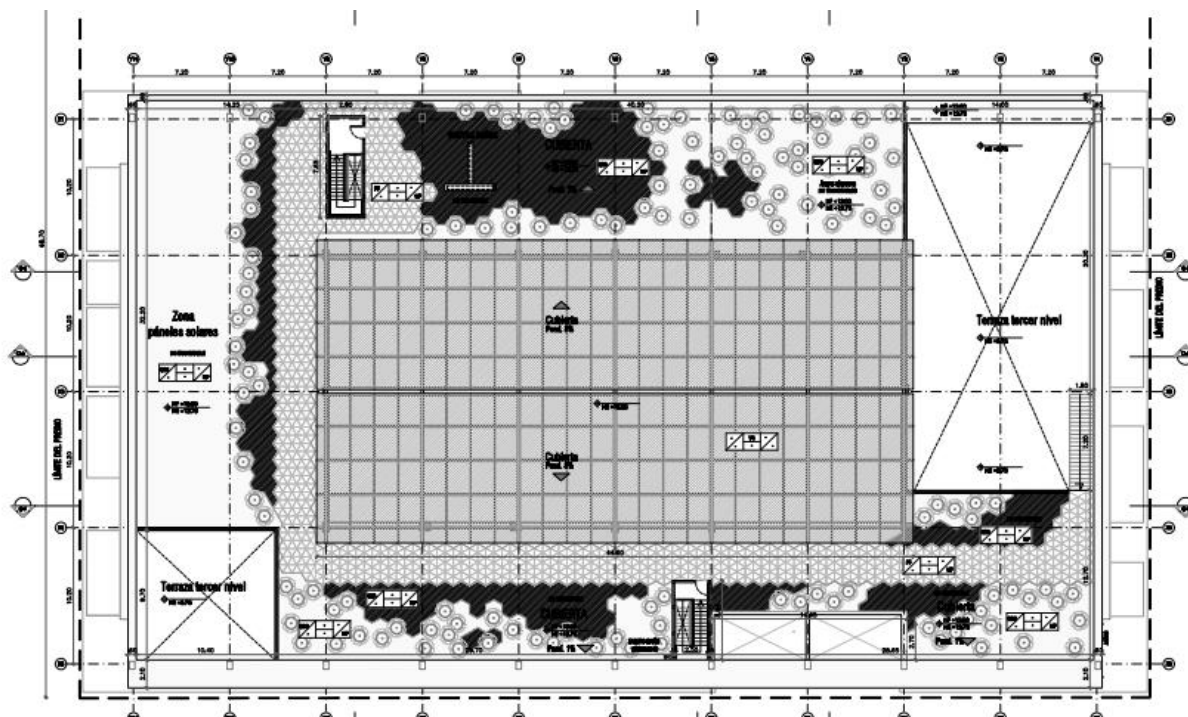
Planta Cubierta. Fuente: Planos arquitectónicos
